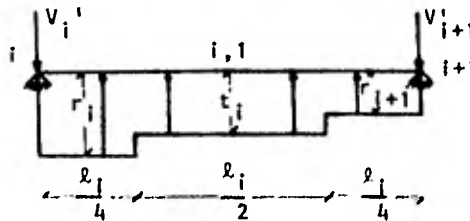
reacción del terreno sobre una viga simplemente apoyada.
